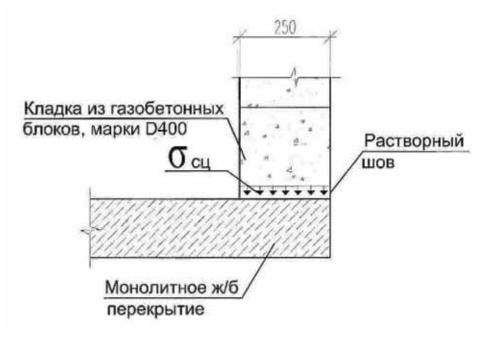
Схема сцепления первого ряда кладки с монолитным перекрытием
